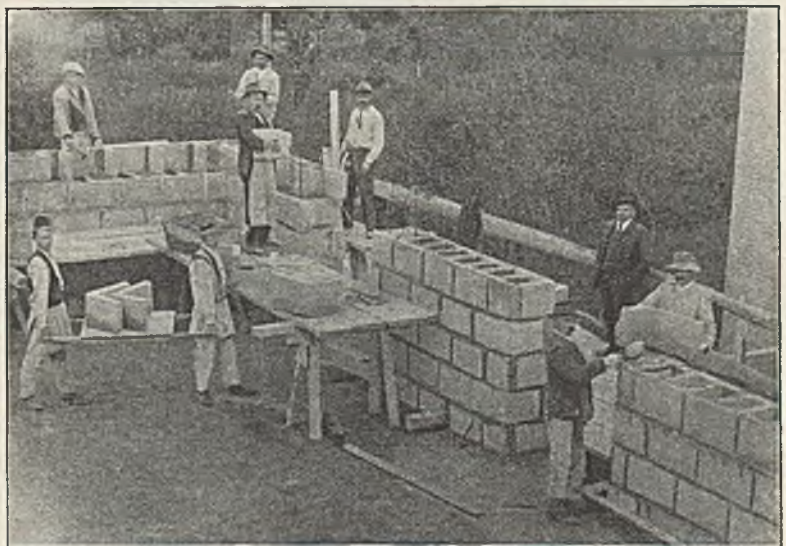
Aufführung einer Mauer mit Hakensteinen.
